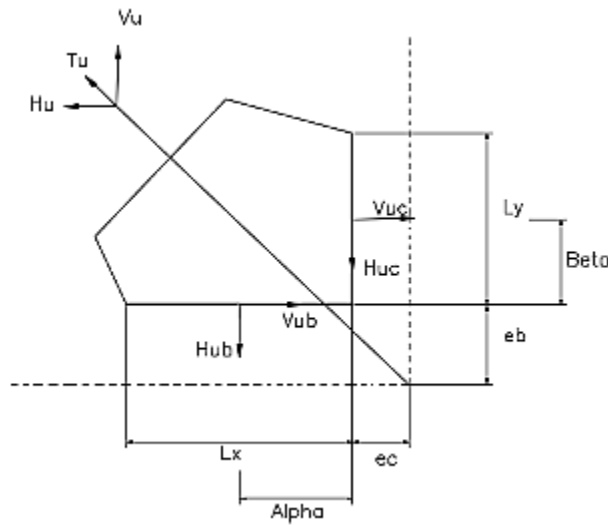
Geometría de plancha. Fuente: Propia realizado en AUTOCAD.
